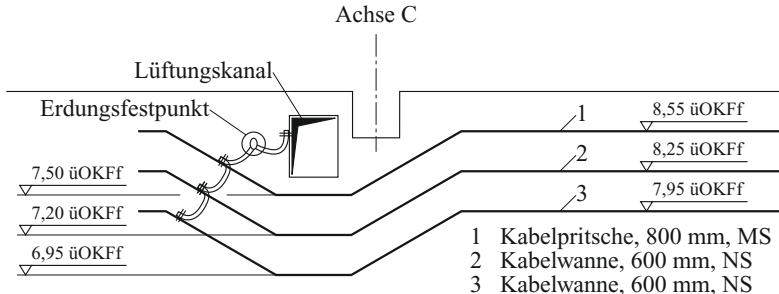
Grundrissdarstellung mit Detailzeichnung zur Ausführung des Potentialausgleichs (Erdungssammelleiter) im Technikraum
